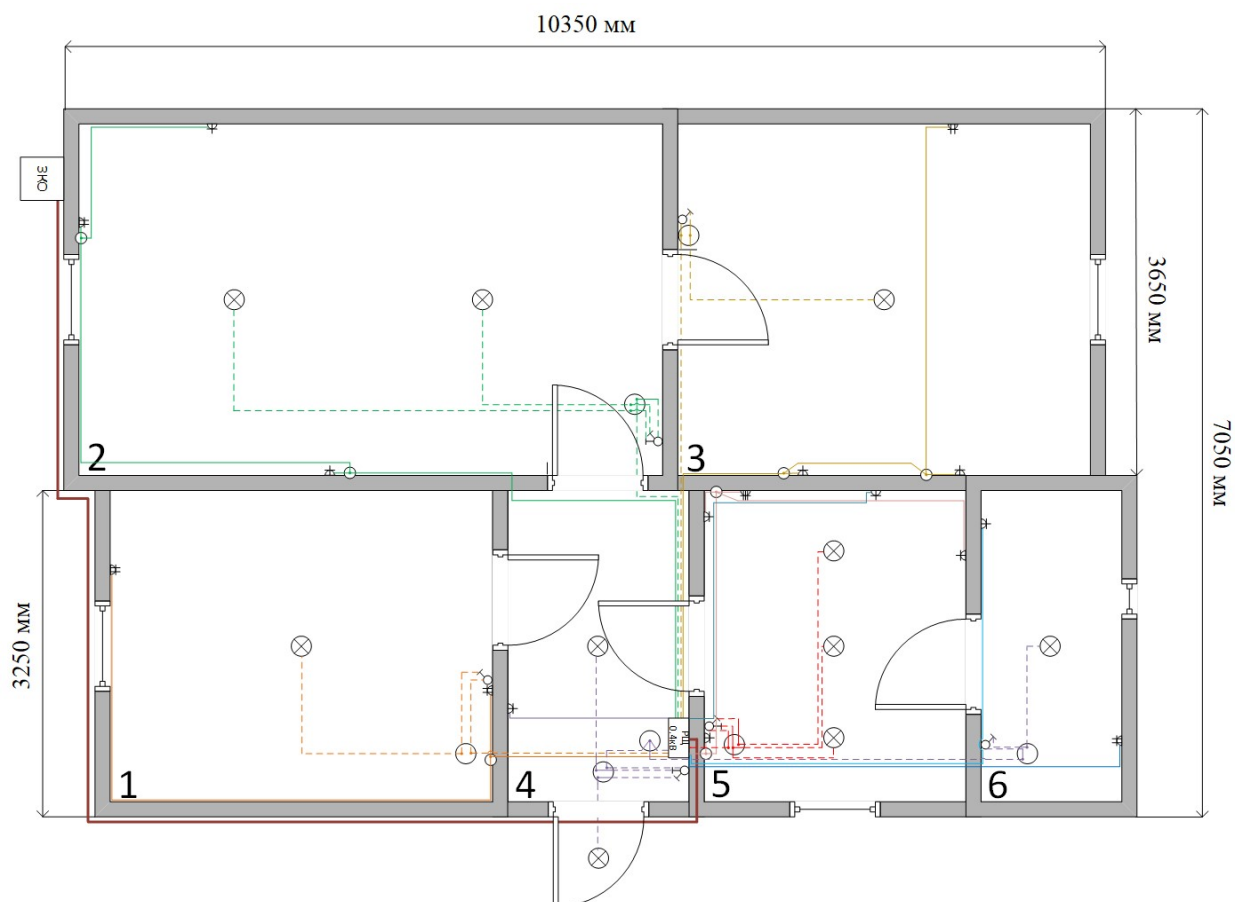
План квартири з силовою та освітлювальною мережами
